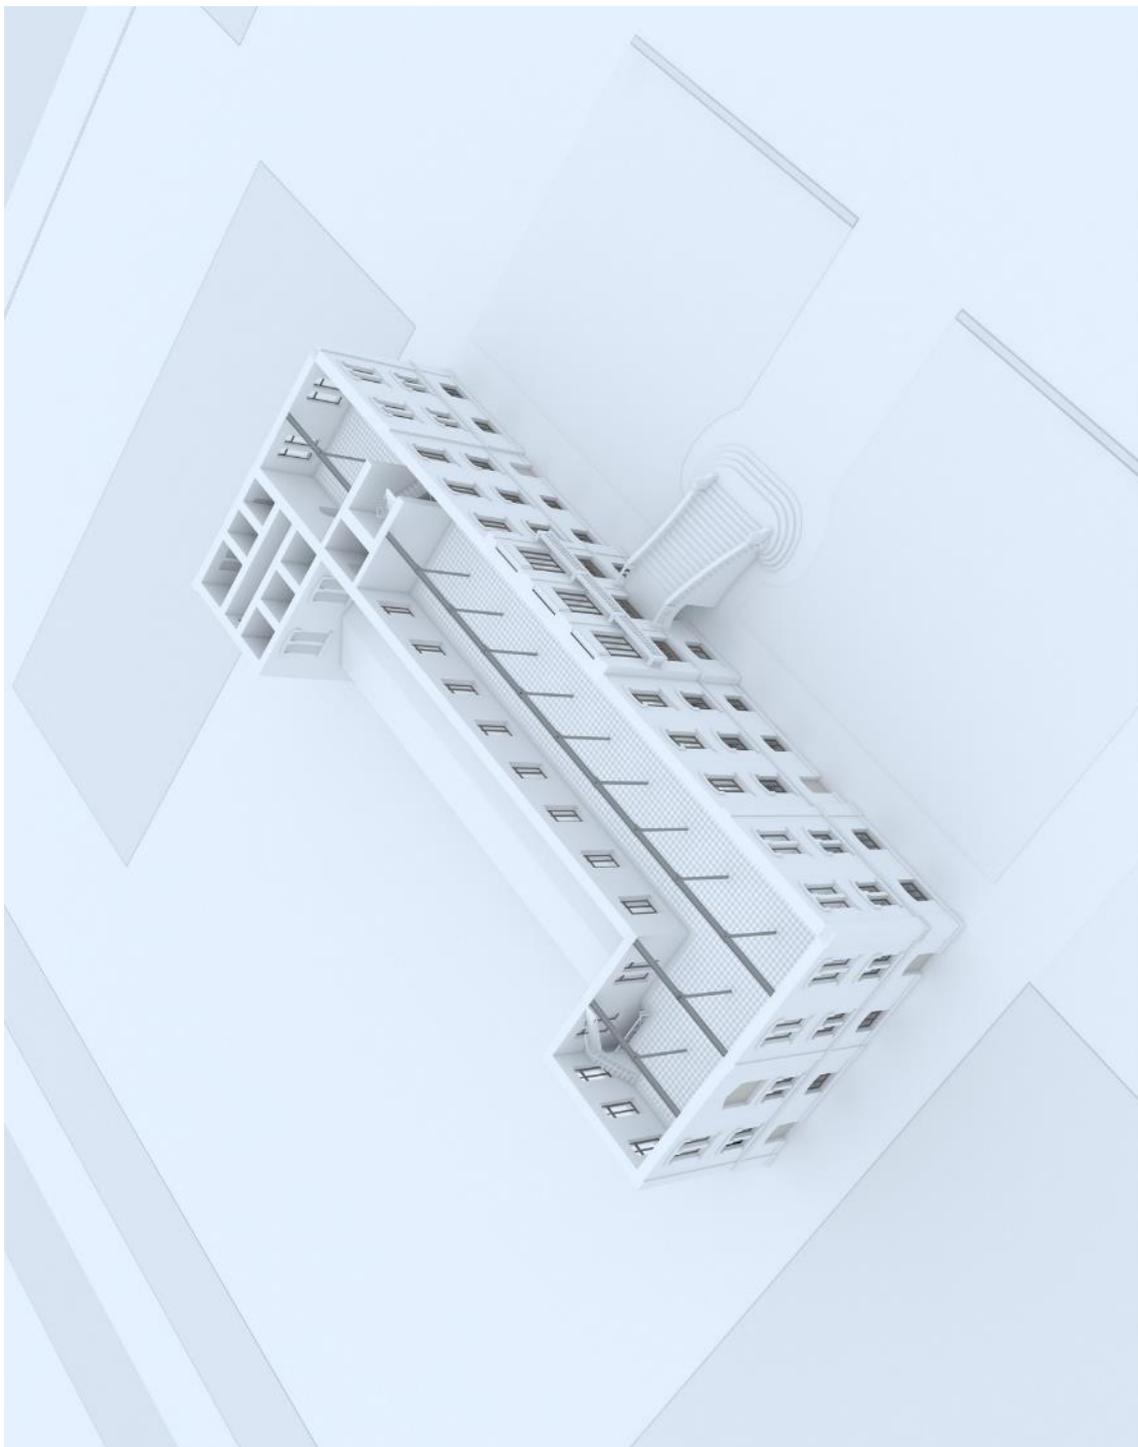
Imagen virtual. La fábrica. Planta segunda. Sección por debajo de las viguetas de forjado.
